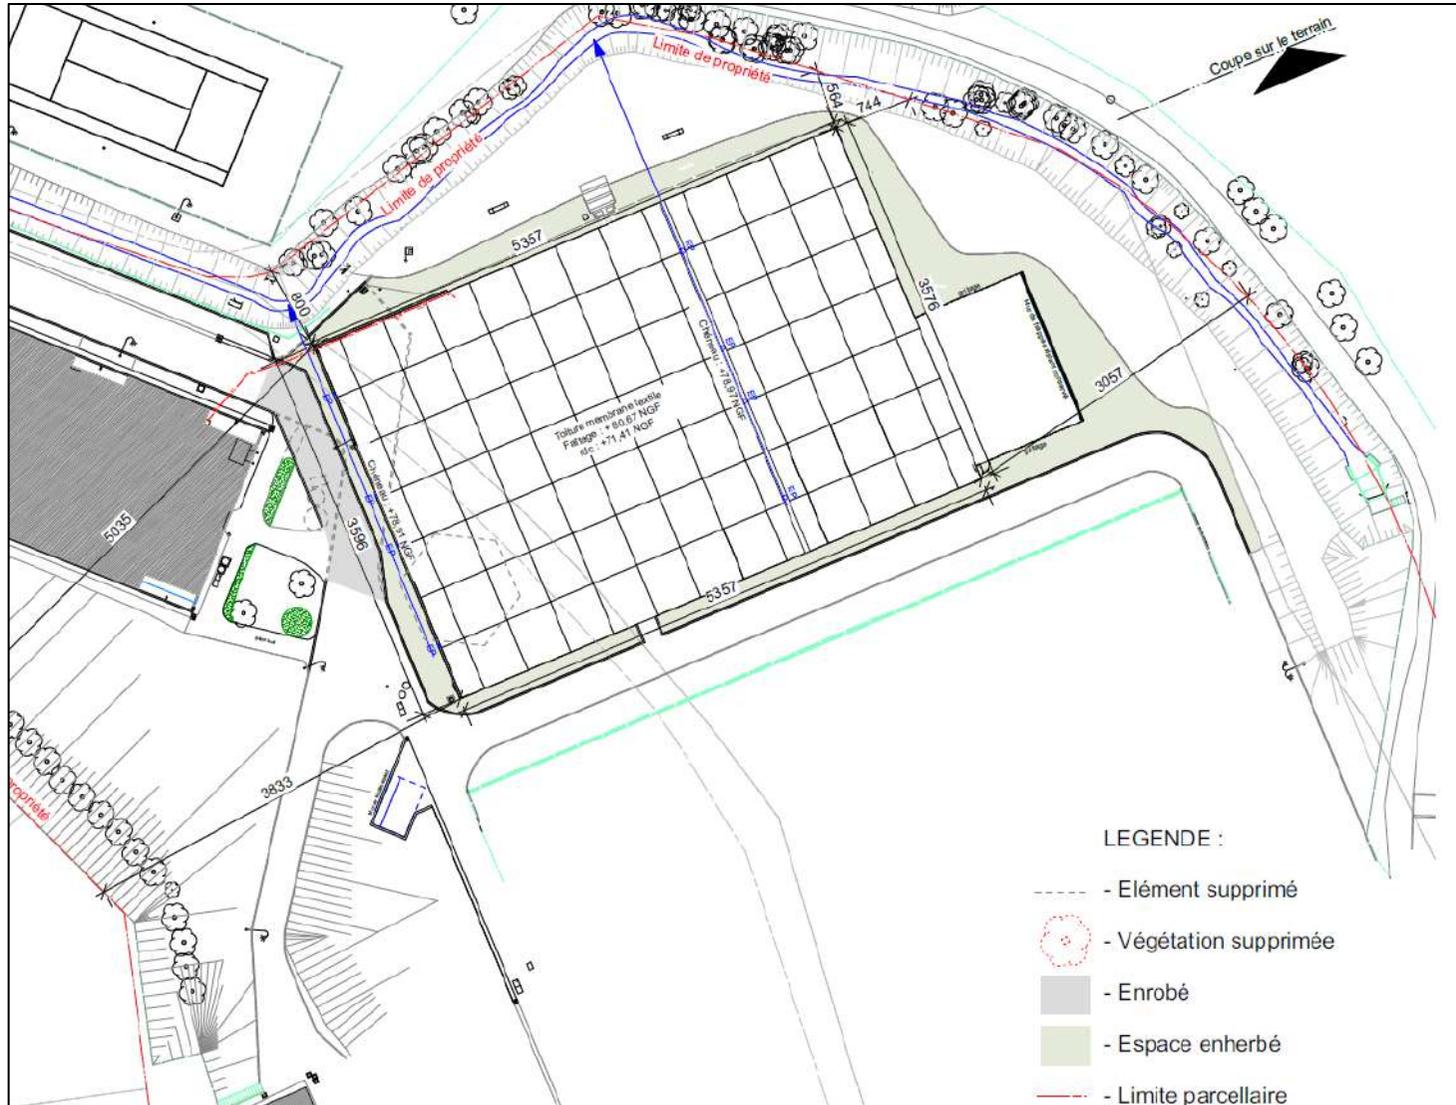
Plan masse projeté des revêtements sur la zone projet - zone A, SAS Architecture 3J
